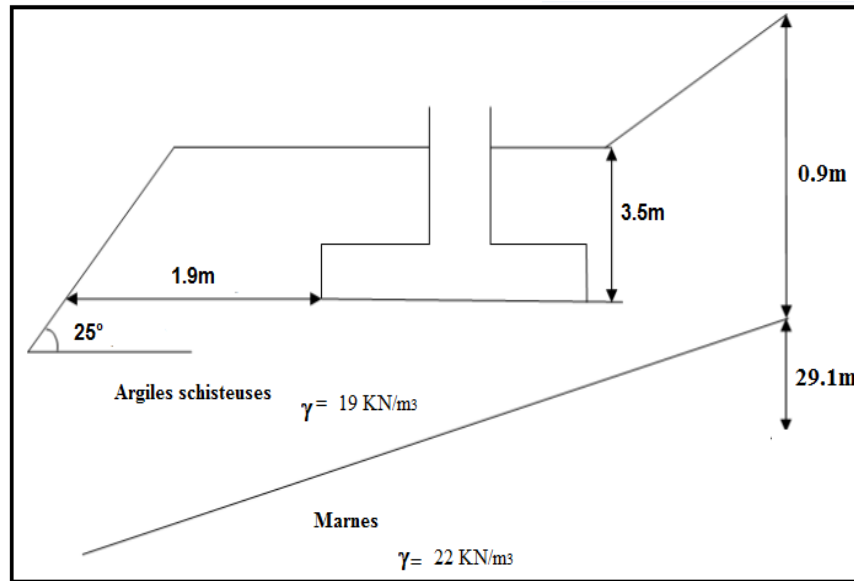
coupe sur le profil de sol sous la fondation (SP 2).
